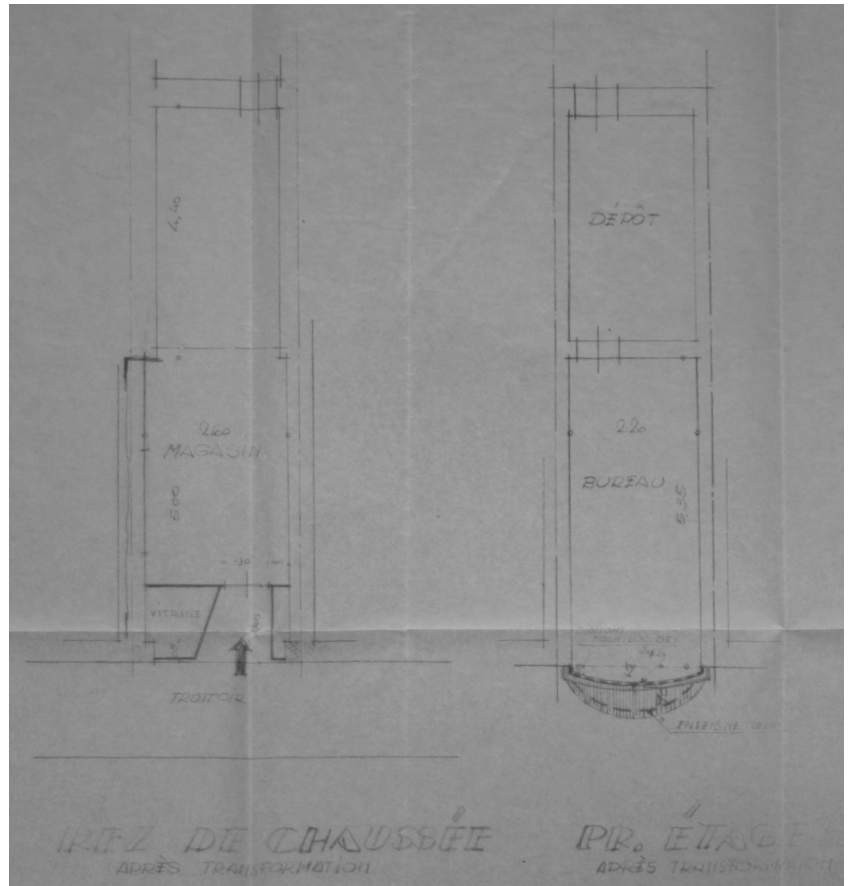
Erdgeschoß und I. Obergeschoß nach dem Umbau 1949
